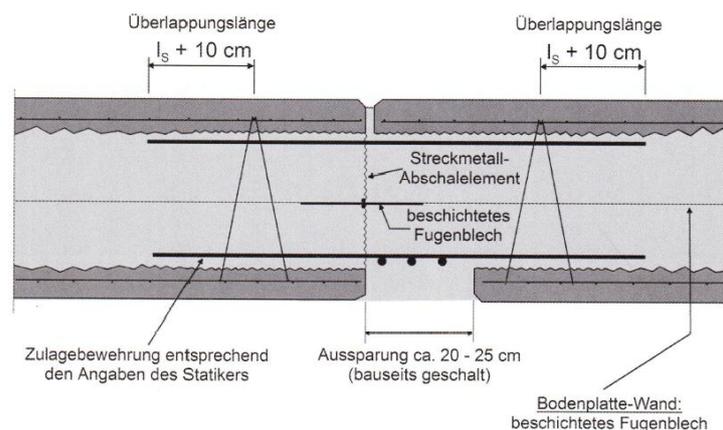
Standardgeometrie der Stoßfugenbewehrung [OBE16]
